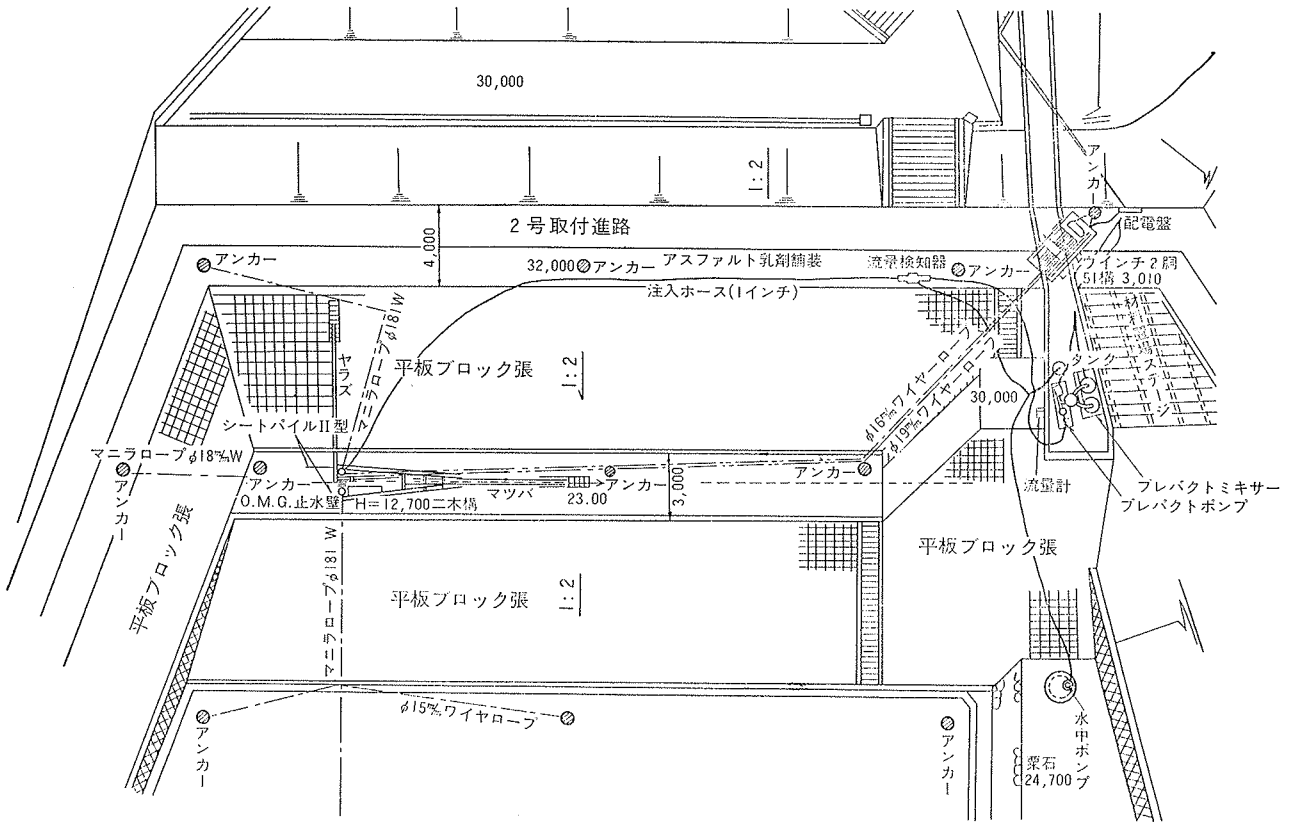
横浜桂台 O.M.G. 壁体造成位置 (平面図)
